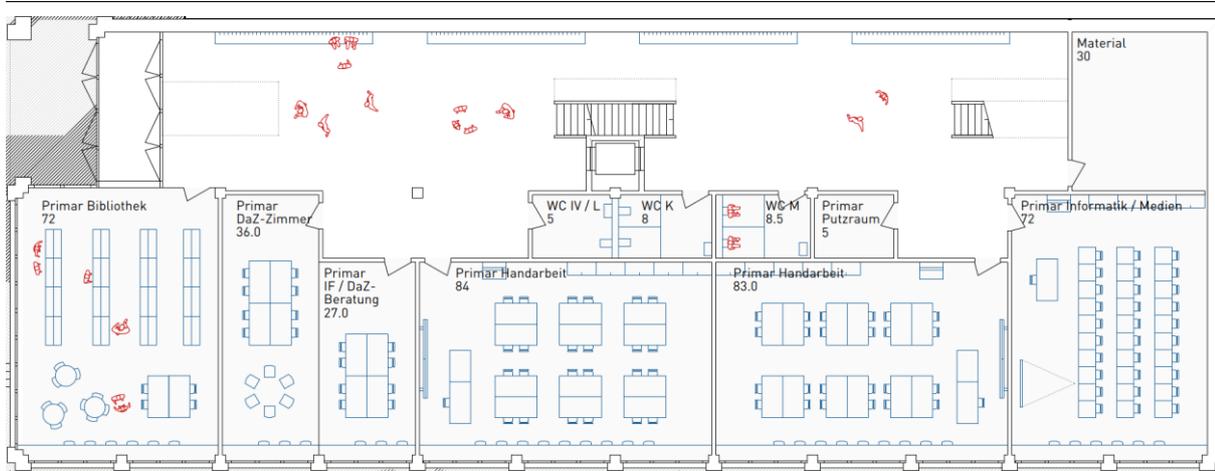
Grundriss Eingangsgeschoss Primar Neubau
